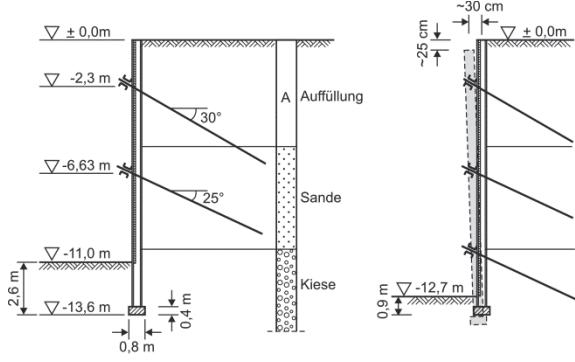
Trägerbohlwandverbau; links: ursprüngliche Planung, rechts: tatsächliche Ausführung mit Verformung nach Schadenseintritt
